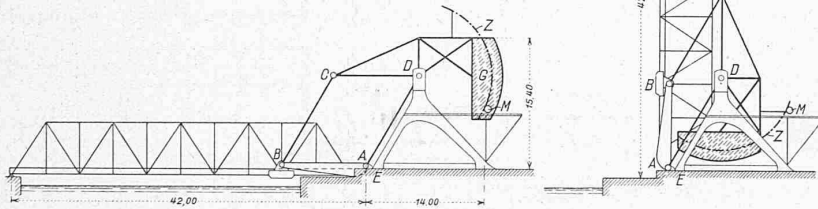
und 2. Schema der Klappbrücke in geschlossener und offener Stellung.
